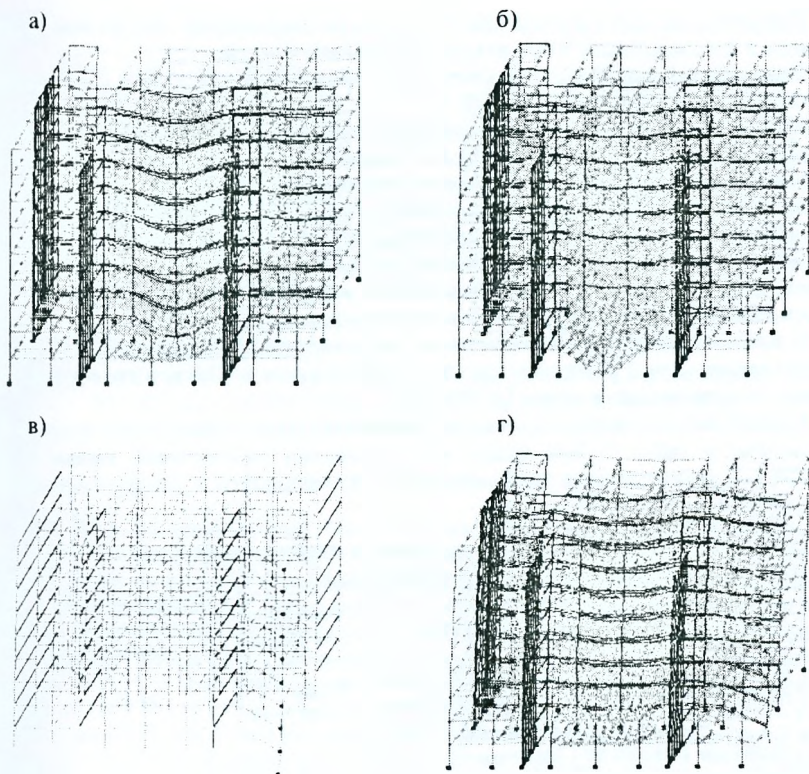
Деформированная схема каркаса здания при удалении конструктивных элементов:
